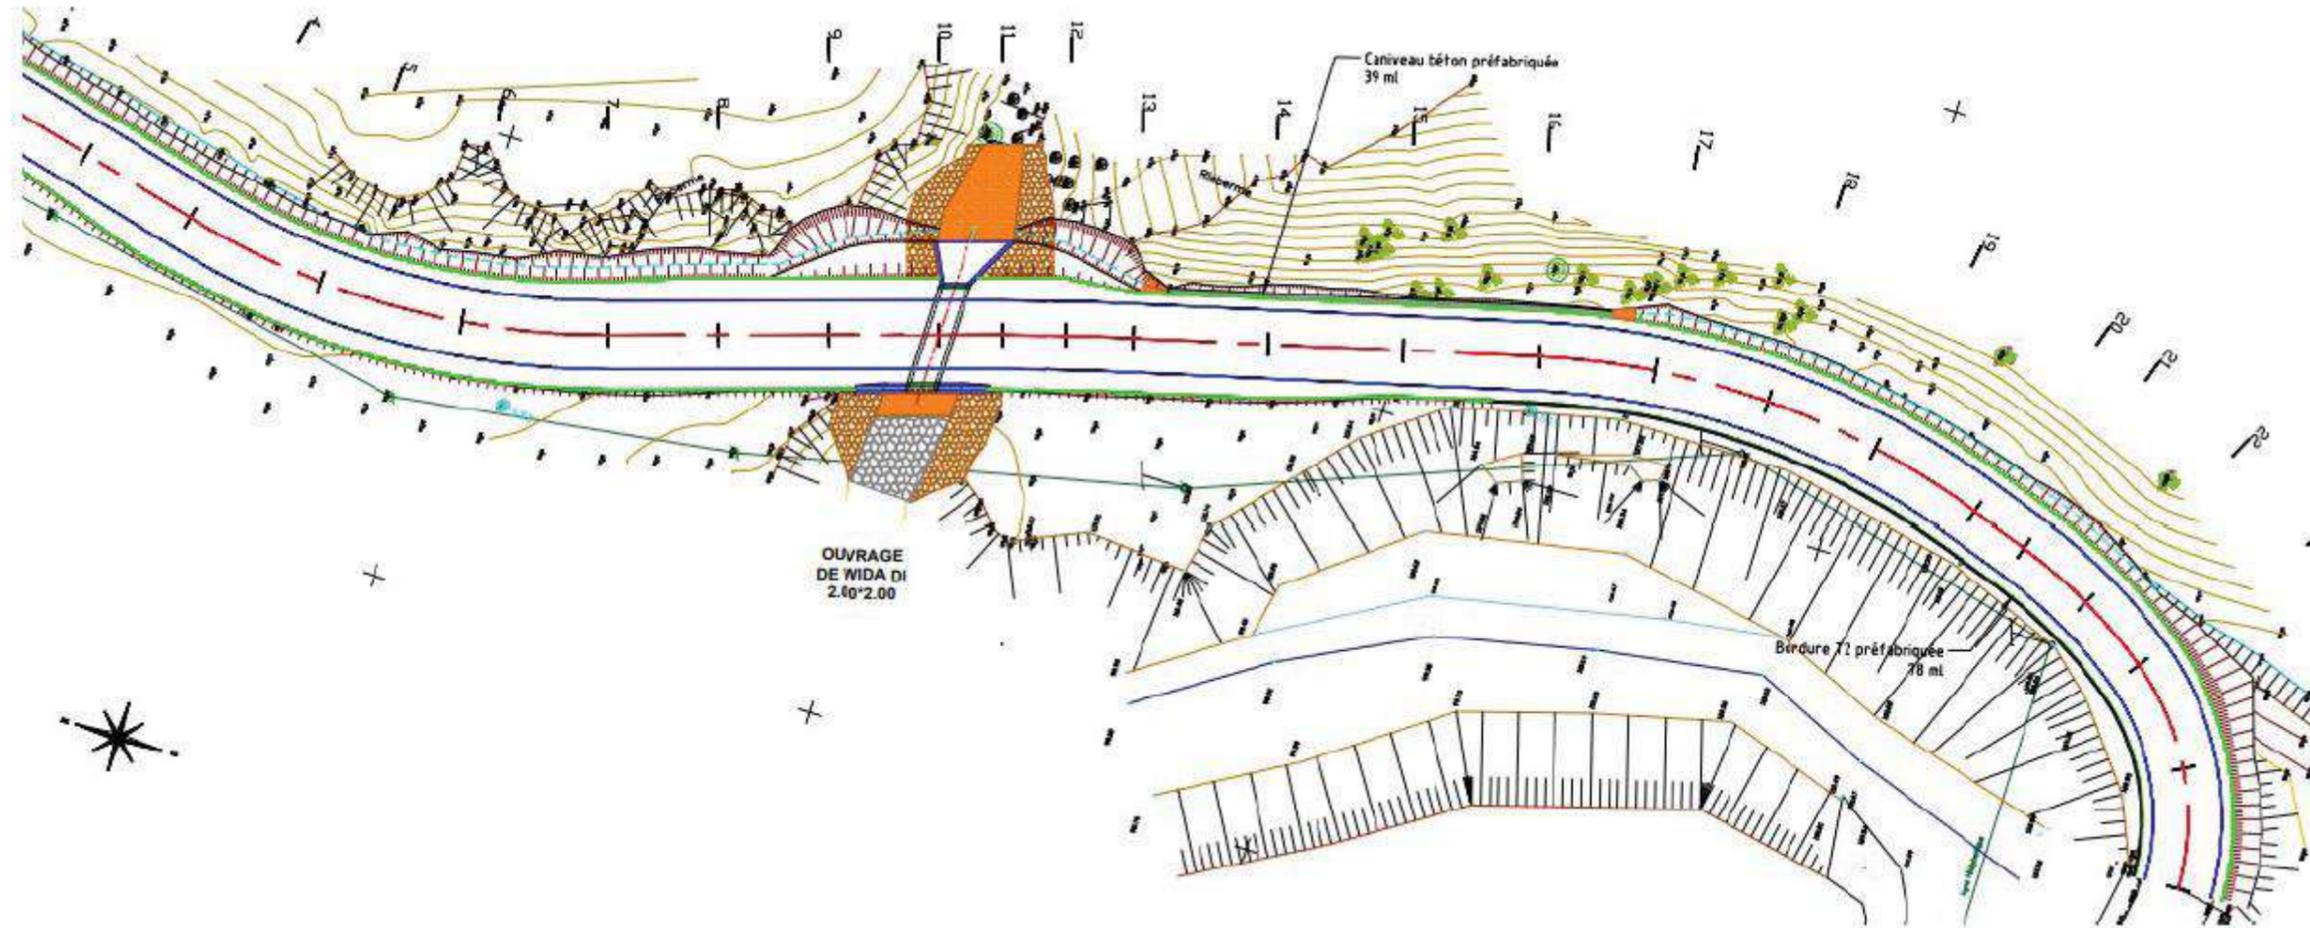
Vue en plan (source : plan APD, ITCE, aout 2023).
